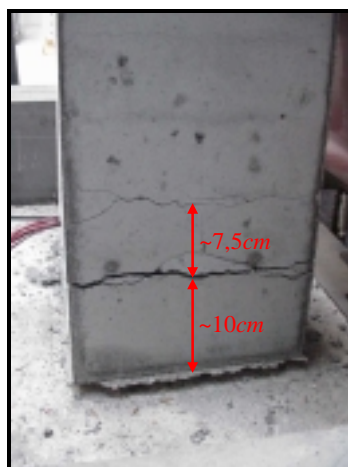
(d) - Fissuração da face traccionada do modelo M4G1.
